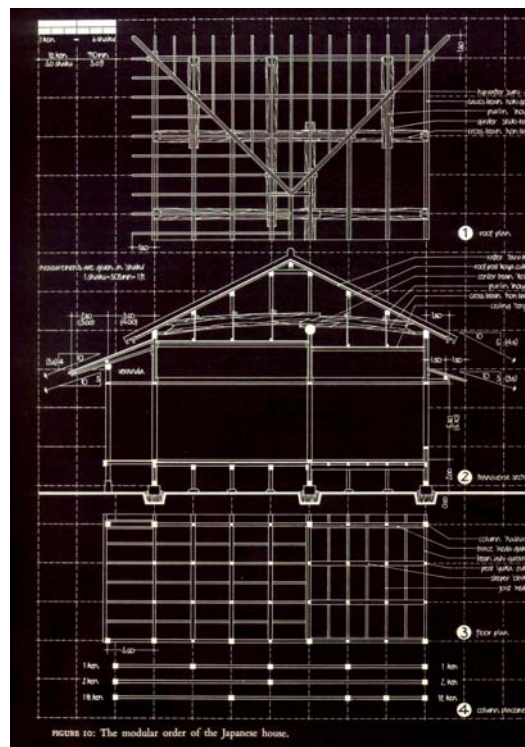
Planta e corte – casa. Fonte: Zwerger (2000)
